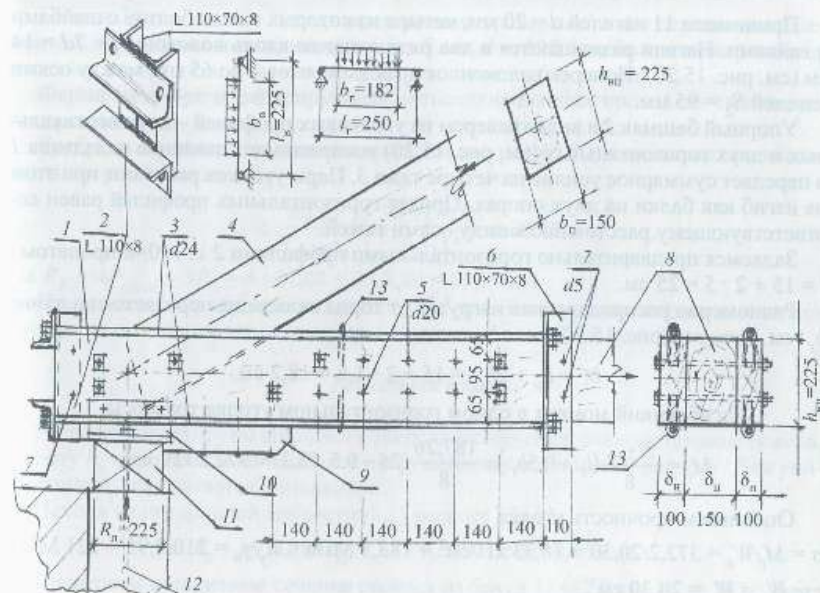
Опорный узел фермы на натяжных хомутах: 1 – деревянный вкладыш; 2 – упорный башмак; 3 – тяжи из круглой стали; 4 – верхний пояс; 5 – расчетные рабочие стальные нагели; 6 – упорные уголки; 7 – гвозди; 8 – нижний пояс; 9 – подкладка; 10 – крепежный уголок; 11 – антисептированная центрирующая прокладка; 12 – анкерный болт; 13 – фиксирующие скобки
